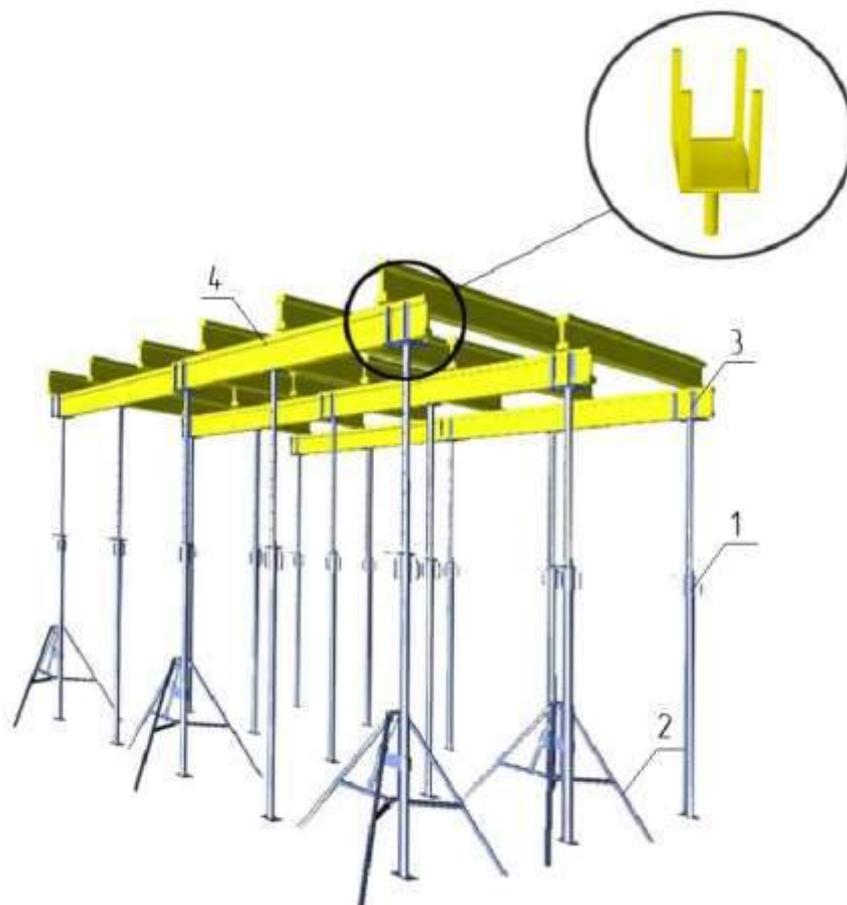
Монтаж поддерживающих элементов опалубки. 1-стойка, 2-тренога, 3-унвилка, 4-балка.
